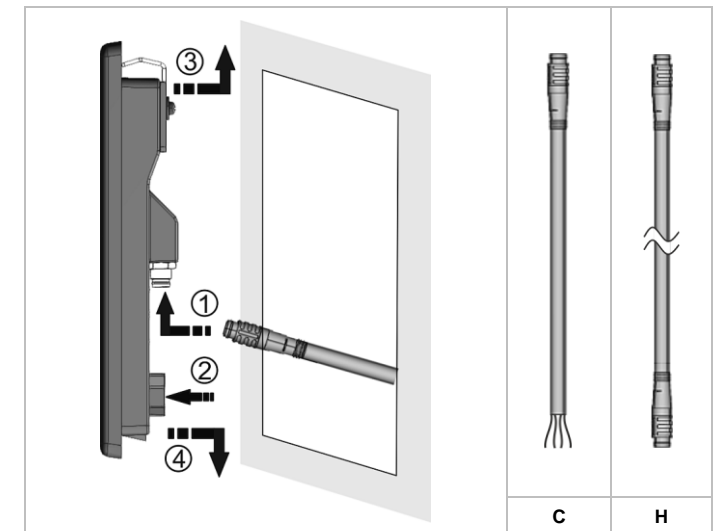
Montage in der Torzarge / Flush mounting / Montage dans le cadre de portail
